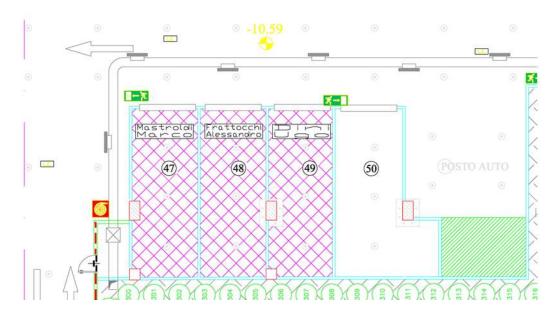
Autorimessa 5 Box 47-48-49-50 posti sotto la griglia di areazione al piano superiore
